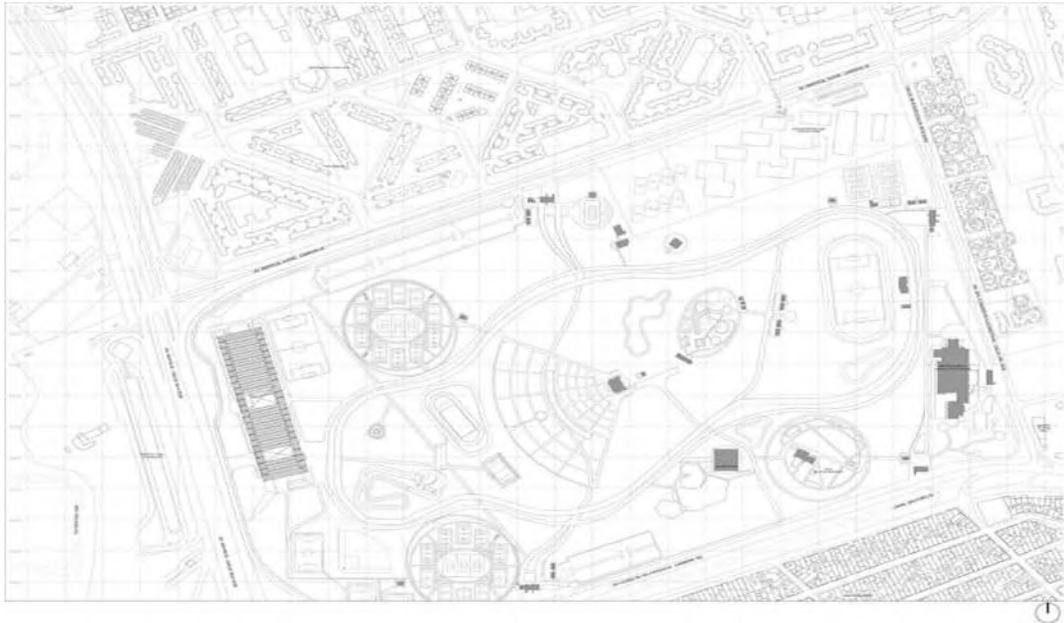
Planta de conjunto del centro deportivo el Tunal, Fuente;
